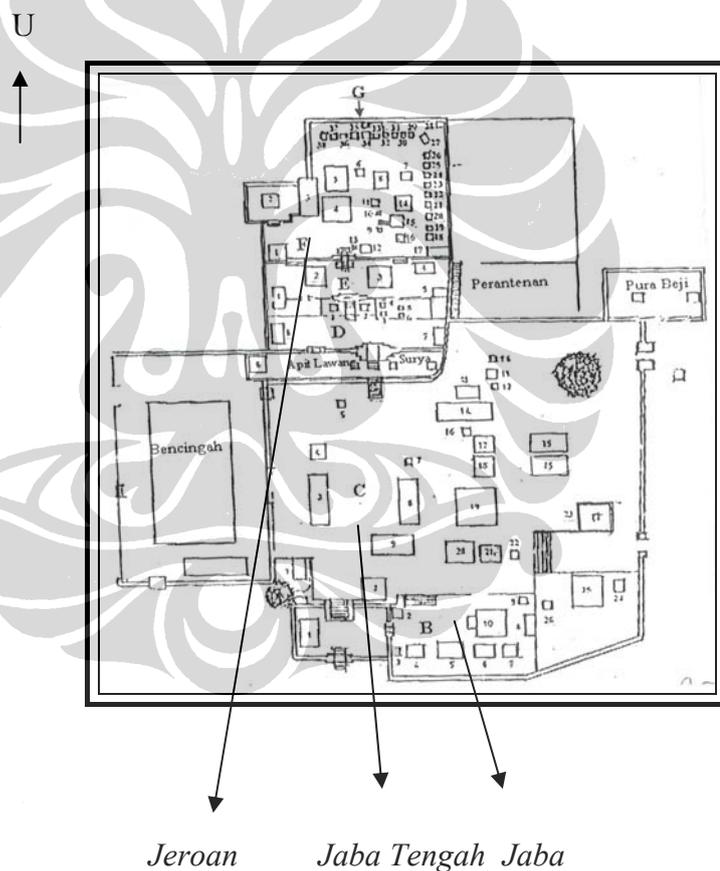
Sketsa Denah *Pura Pusering Jagat
